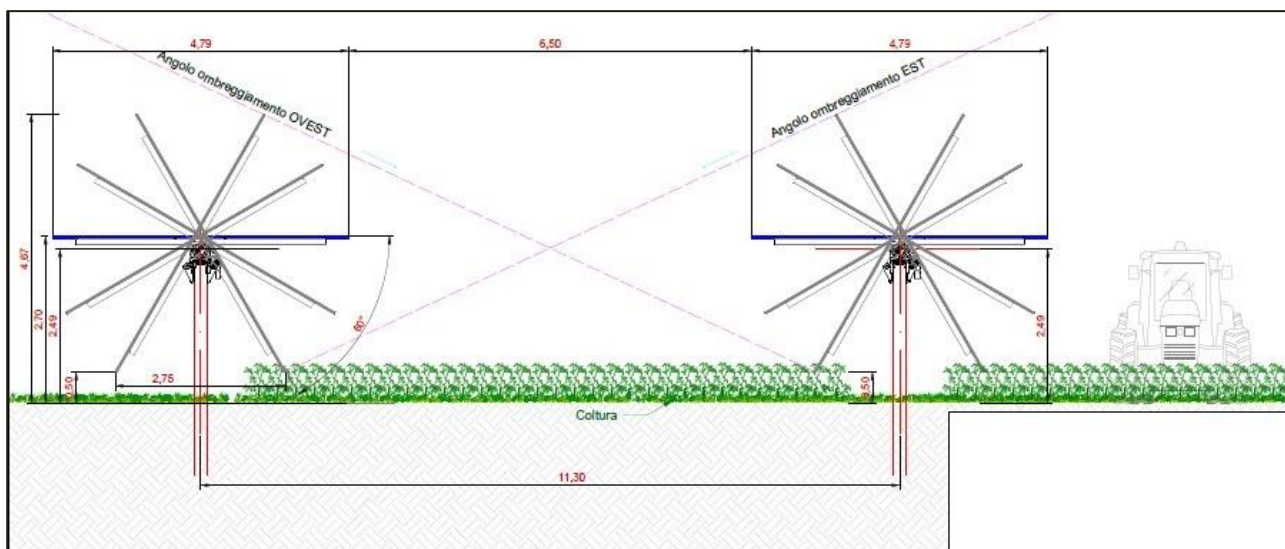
particolare strutture di sostegno moduli e distanza fra le interfile
